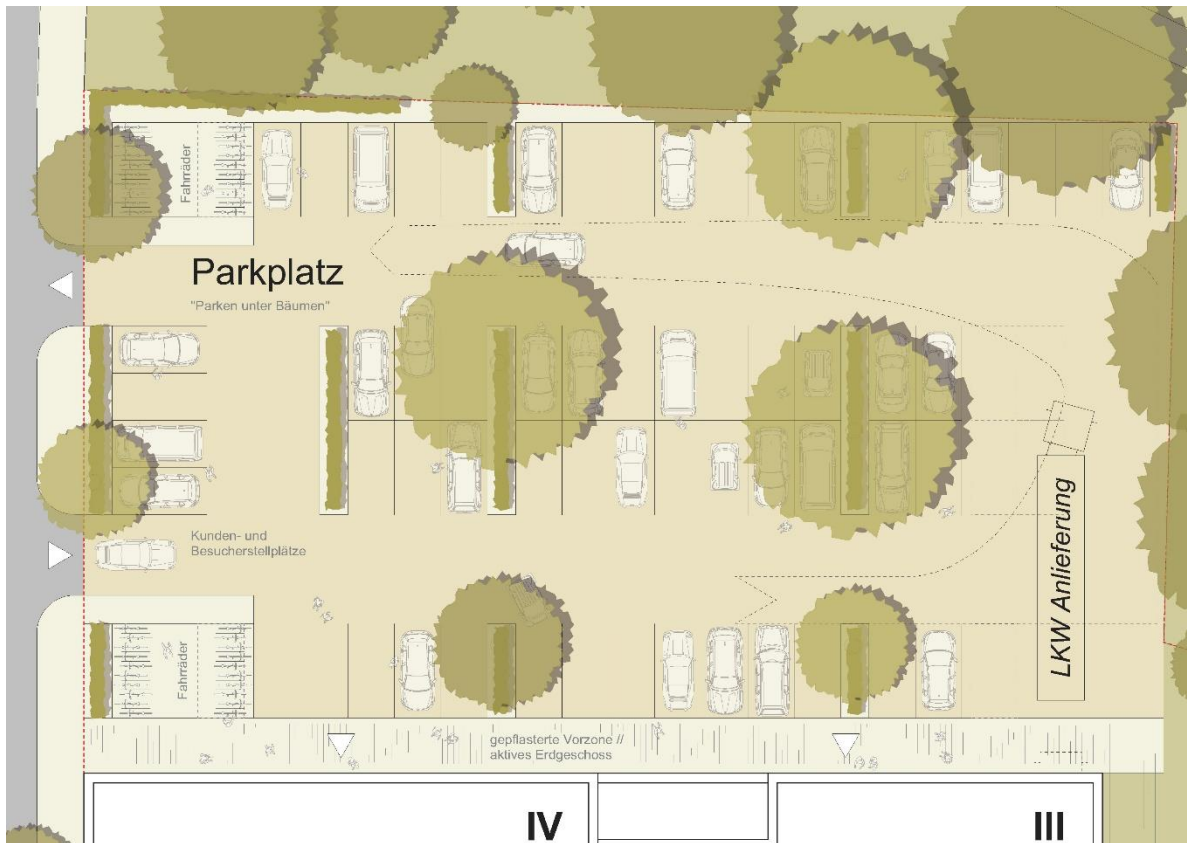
Gestaltungsplan | „Parken unter Bäumen“ © LECKE ARCHITEKTEN
